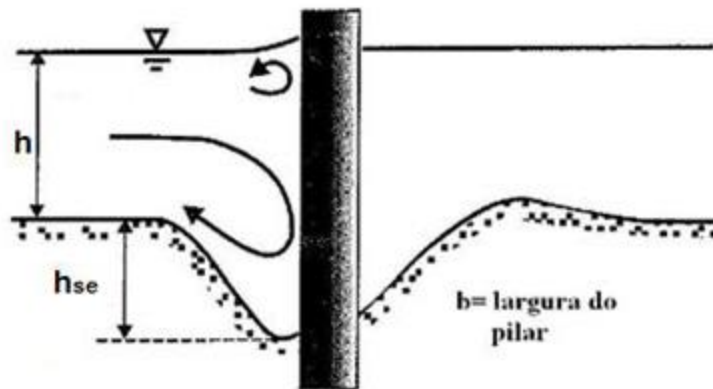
Cavidade de erosão vista em perfil (Adaptado de [3])
